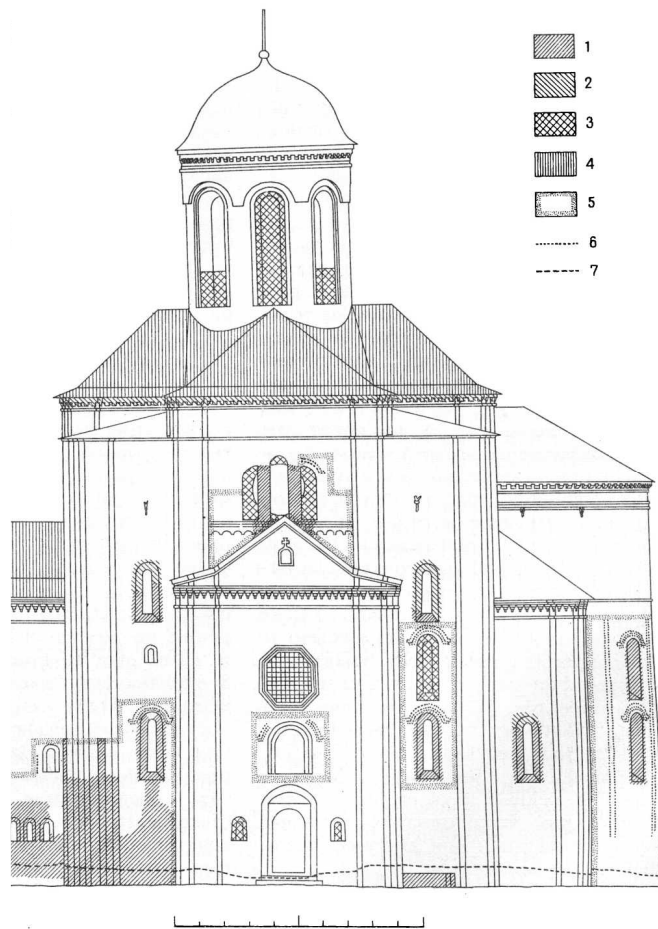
Фасад церкви Михаила Архангела в Смоленске. 1 - восстановление плитфовой кладки; 2 - восстановление кладки из большемерного кирпича; 3 - разборка кладки; 4 - реконструируемые кровли; 5 - участки экспозиции открытой кладки памятника; 6 - выявление сбитых старых деталей; 7 - существующий уровень земли.
